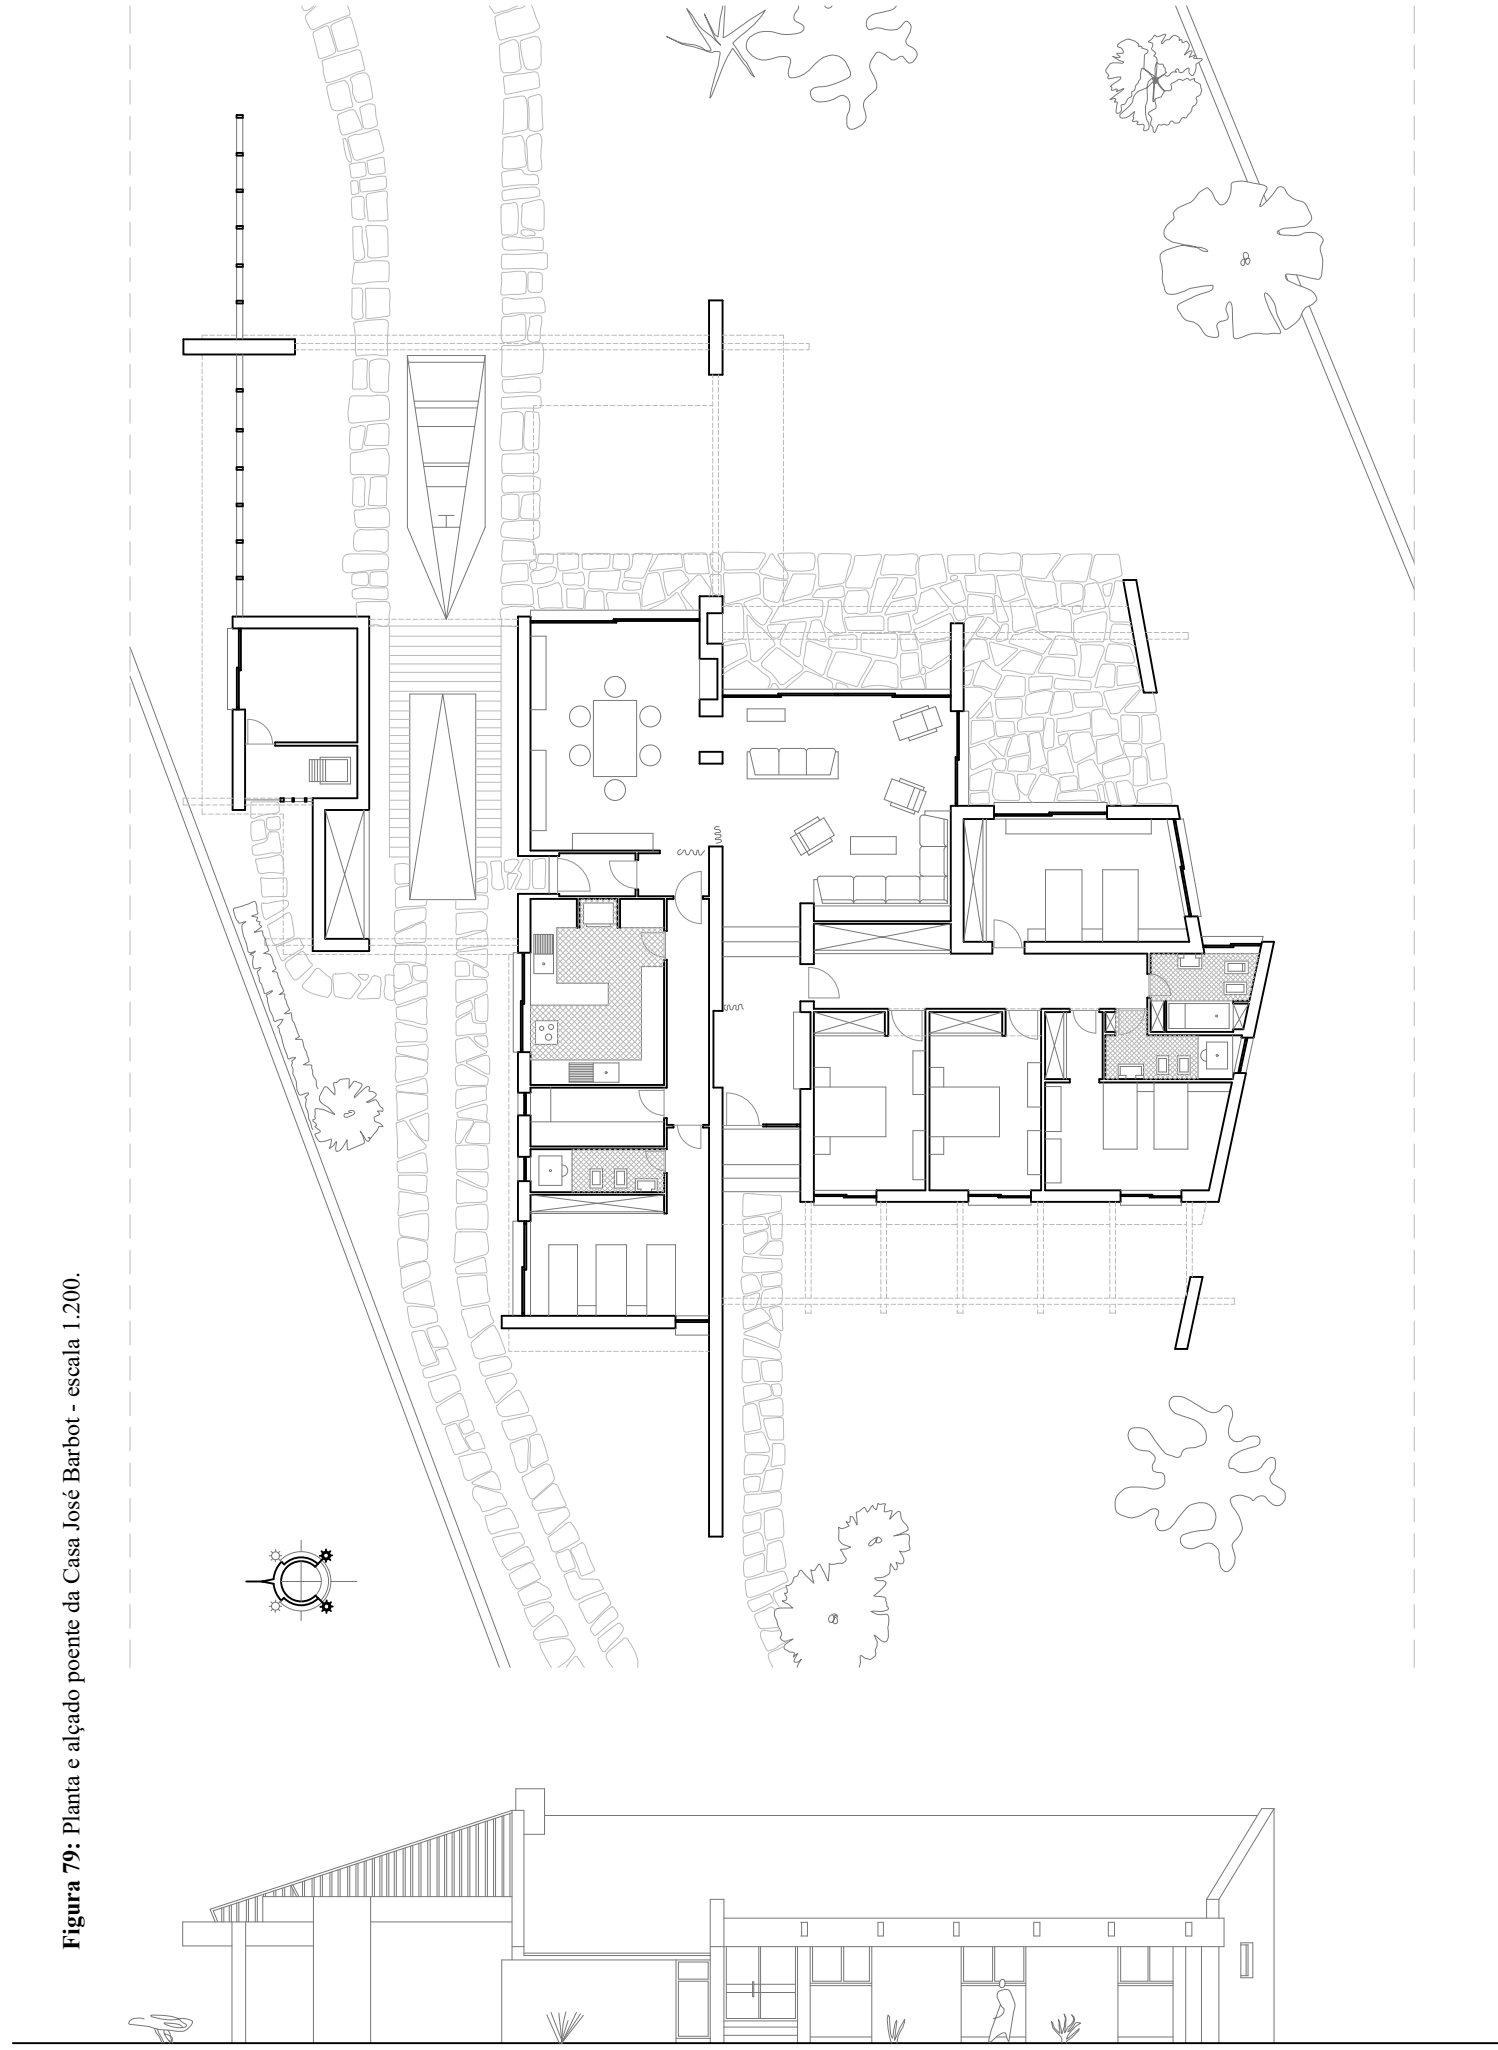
Planta e alçado poente da Casa José Barbot - escala 1:200.
